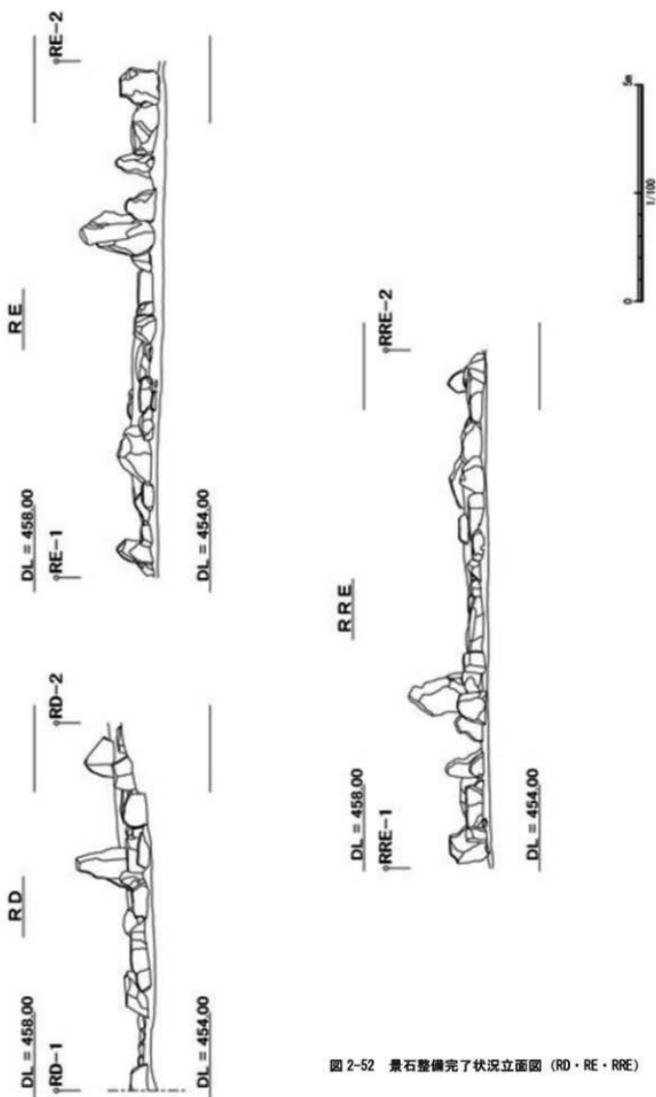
景石整備完了状況立面図 (RD・RE・RRE)
